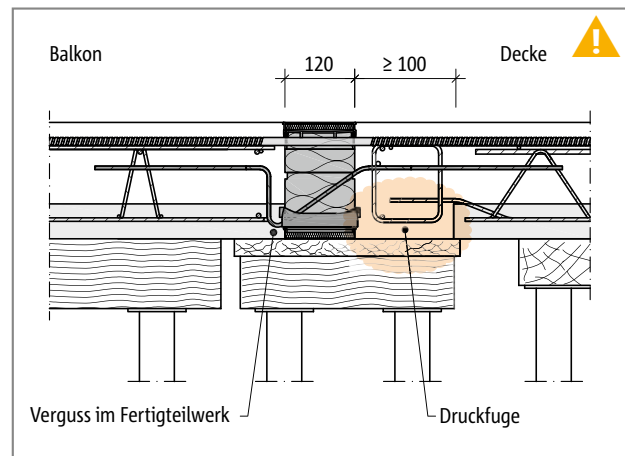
Schöck Isokorb® CXT Typ K-F: Druckfuge deckenseitig in Verbindung mit Elementplatten; indirekte Lagerung
